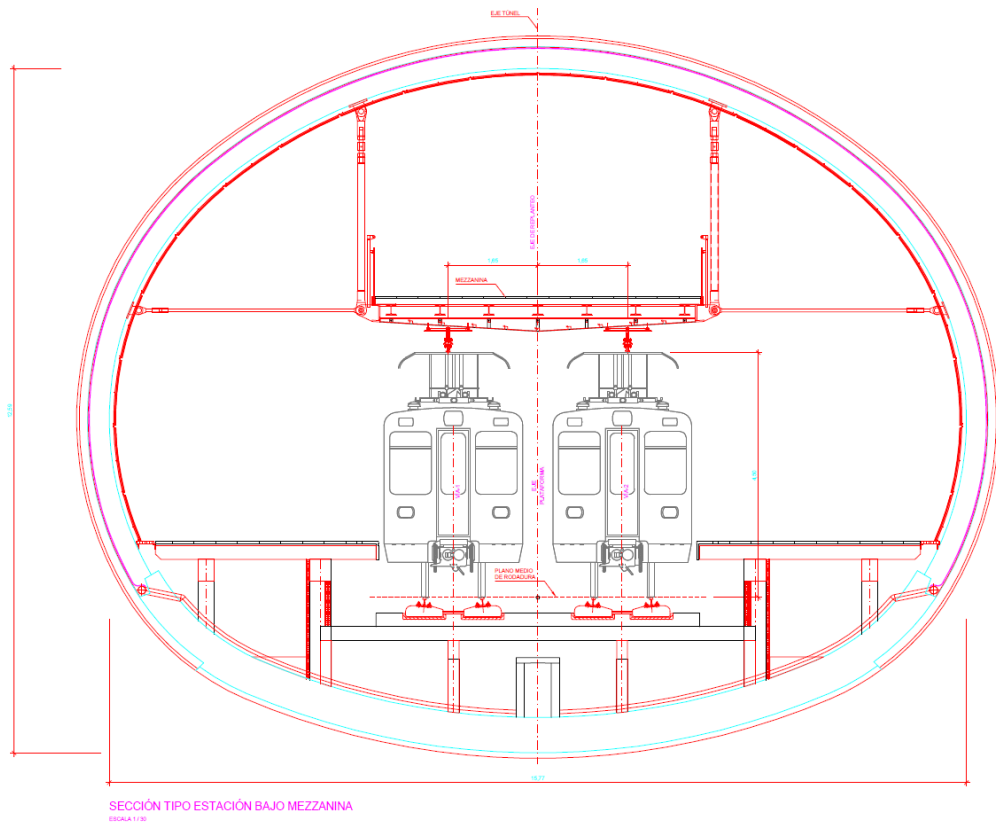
Sección tipo bajo mezzanina - Soporte tipo E
